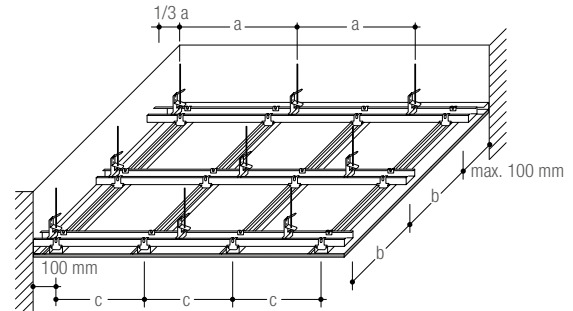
Abgehängte Metallunterkonstruktion nach DIN 18181
